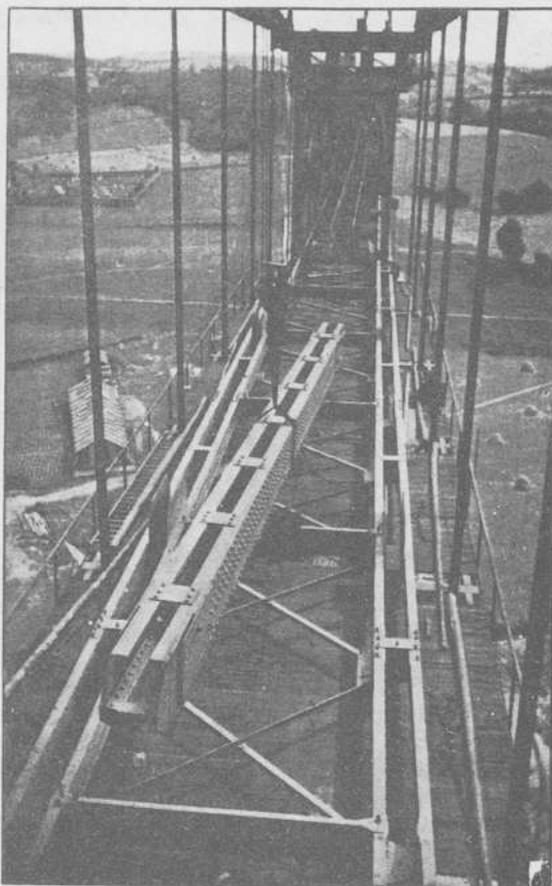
Vue du plancher de travail et d'un tablier en cours de montage.
